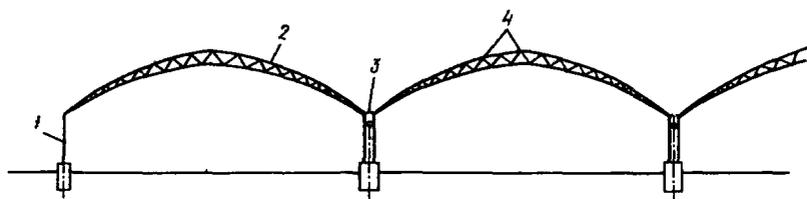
Поперечный разрез блочной теплицы с конструкциями из горячекатаных профилей:
